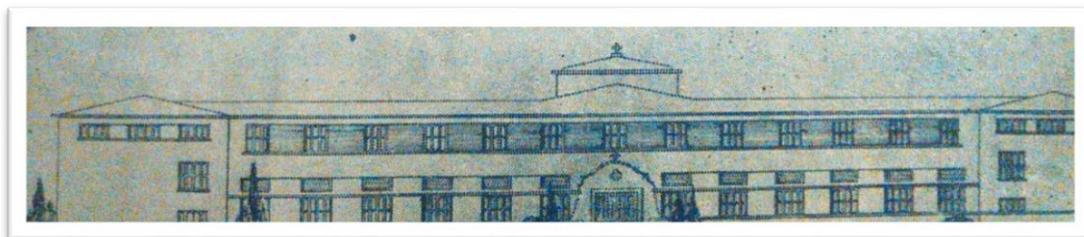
Plano fachada del colegio Santísima Trinidad⁴⁷⁵.
